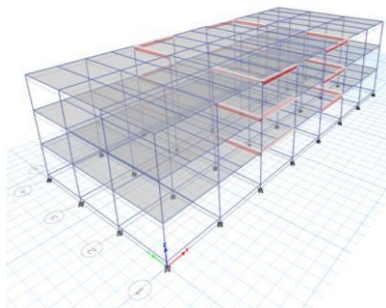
Denah Struktur bangunan gedung rusun tiga lantai
